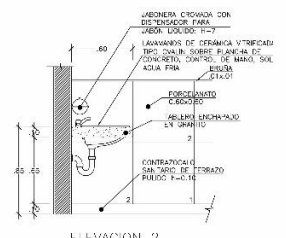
Plano de Detalles Arquitectónicos (Baño de Discapitados) - Elaboración propia
